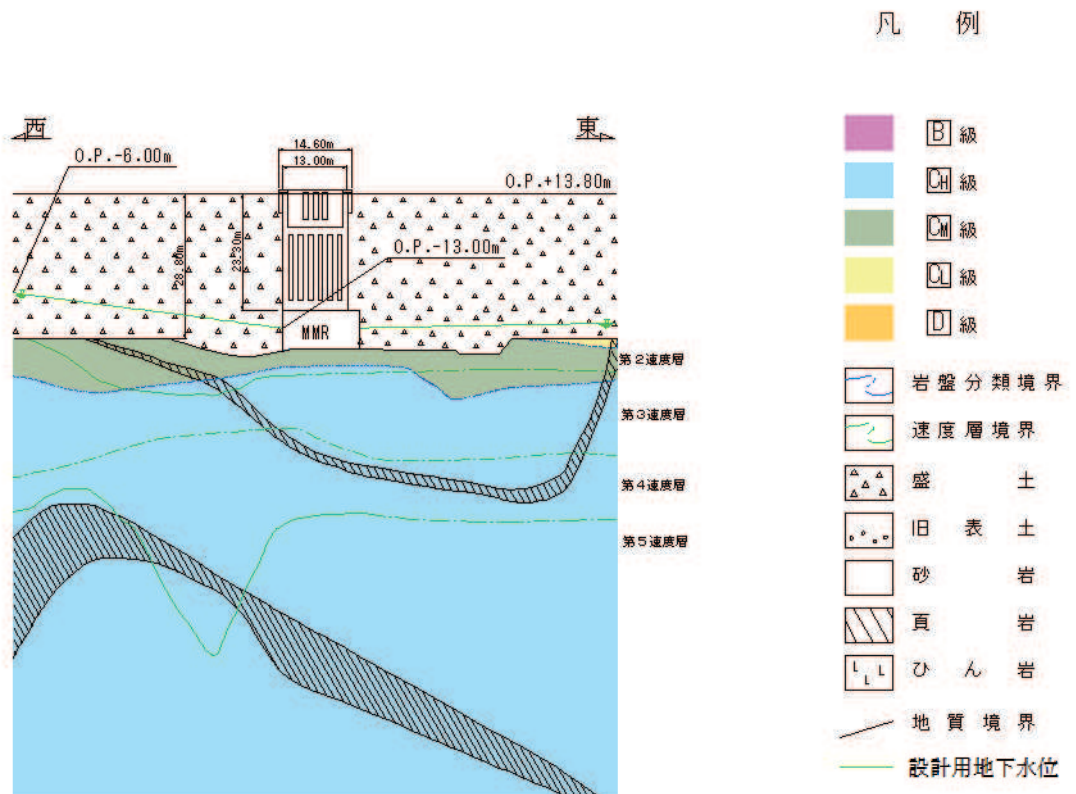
(3) 第 3 号機補機冷却海水系放水ピットの解析断面図 (EW 断面) (3/3)
